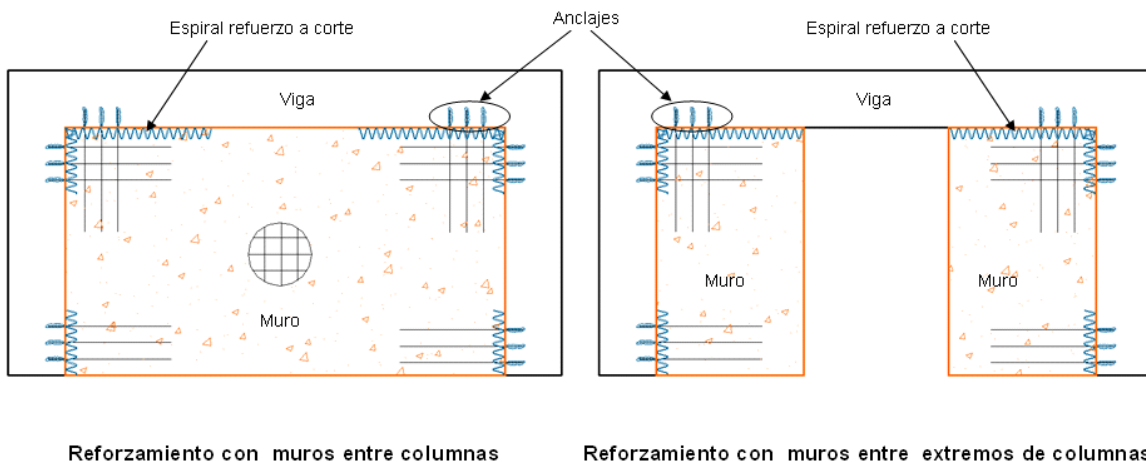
Esquema ilustrativo para reforzamiento con muros estructurales
